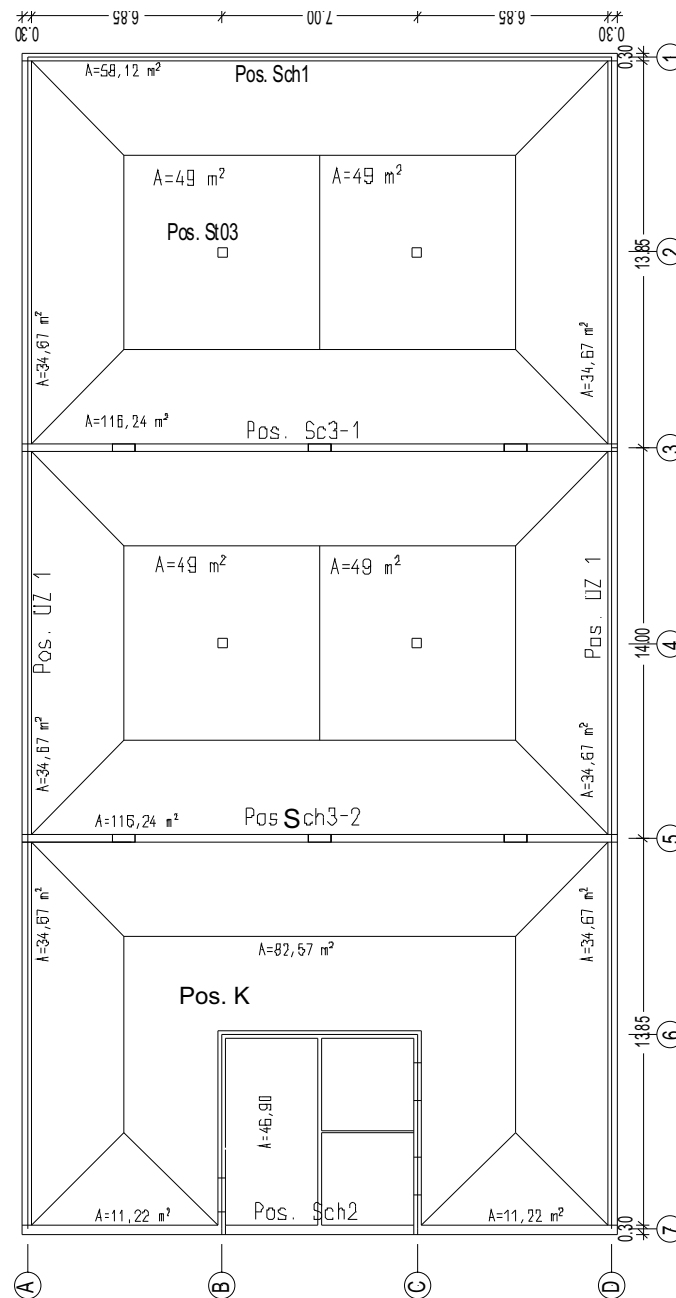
Lasteinzugsfläche [Pos.Decke]
